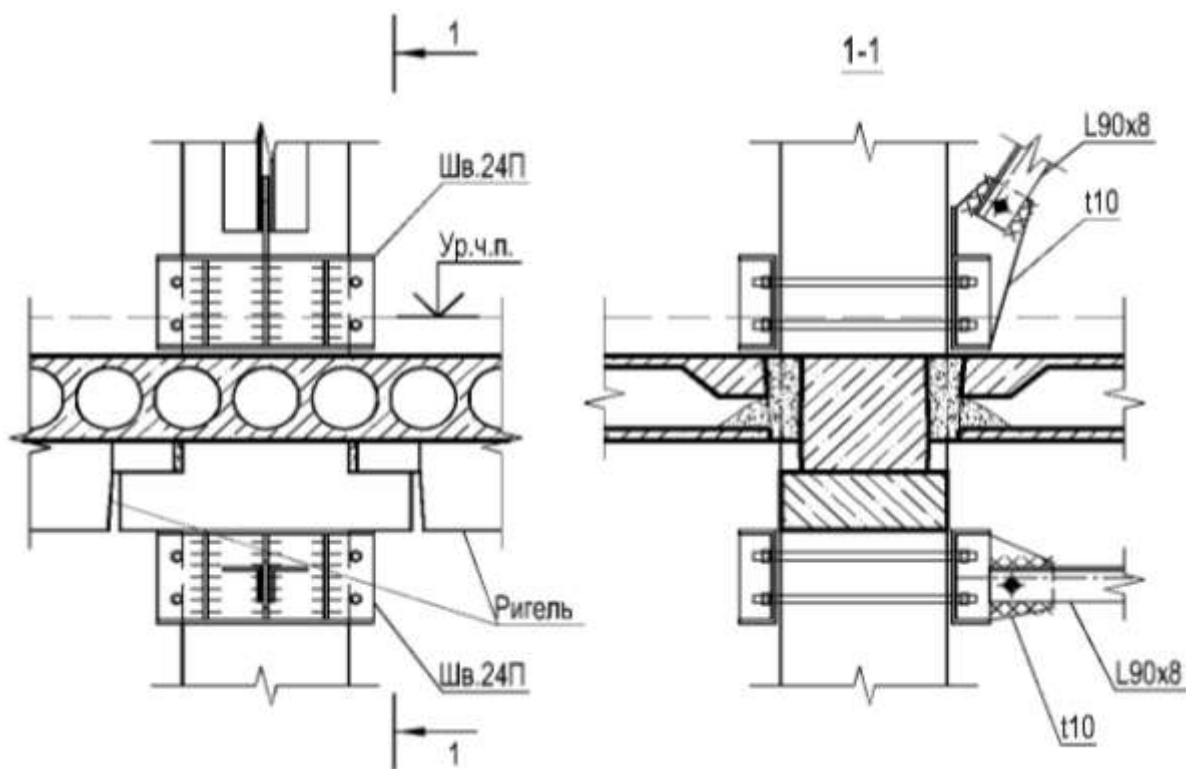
Крепление продольных связей к колонне без её усиления
